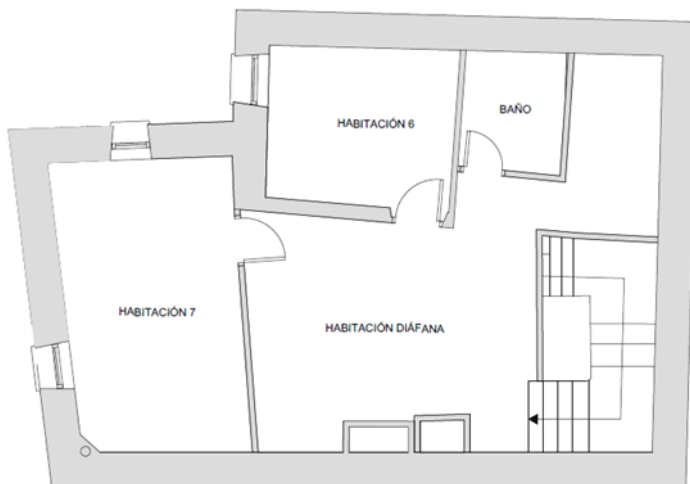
Plano de distribución de planta segunda. Fuente: Autor.
